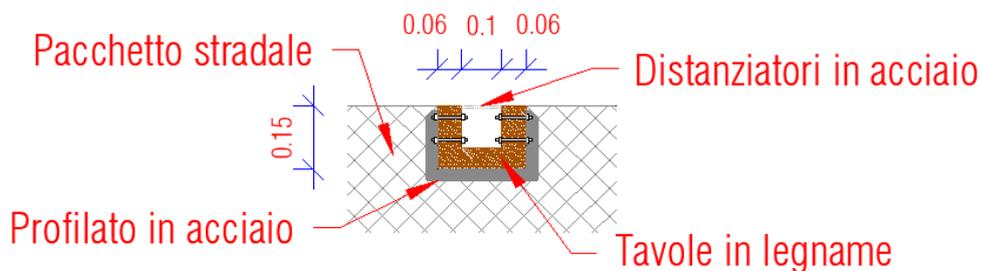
Estratto dalla tavola di progetto - Canaletta trasversale
